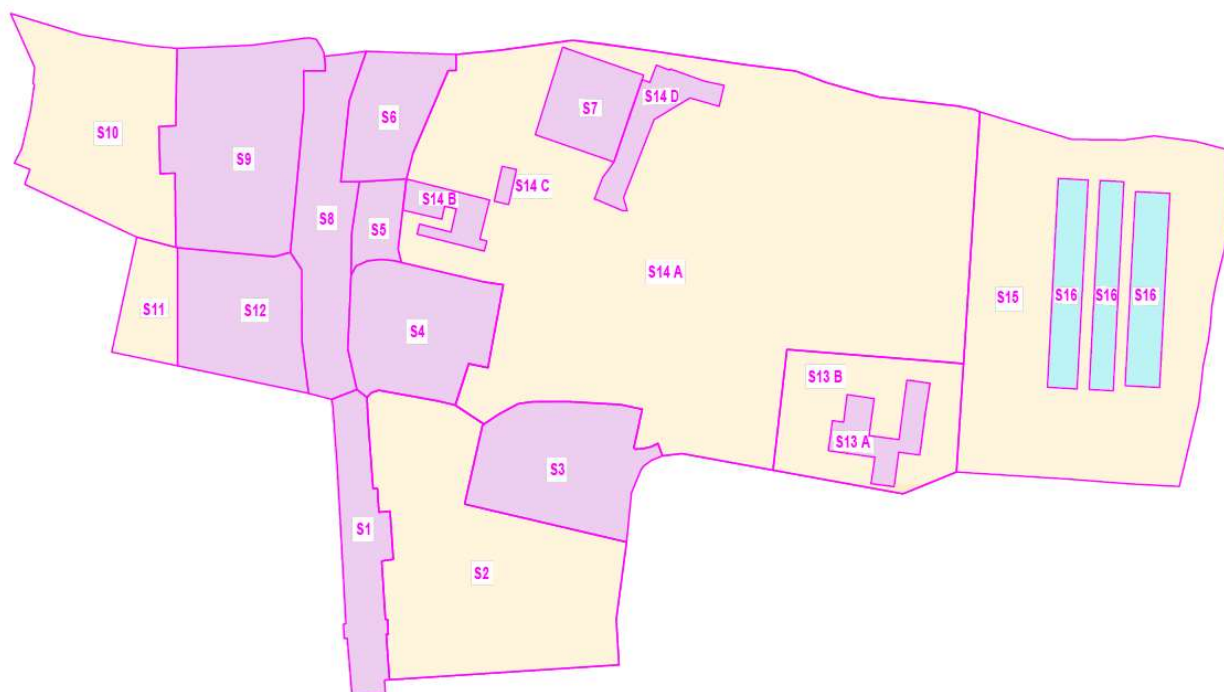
Identificazione planimetrica delle superfici scolanti
